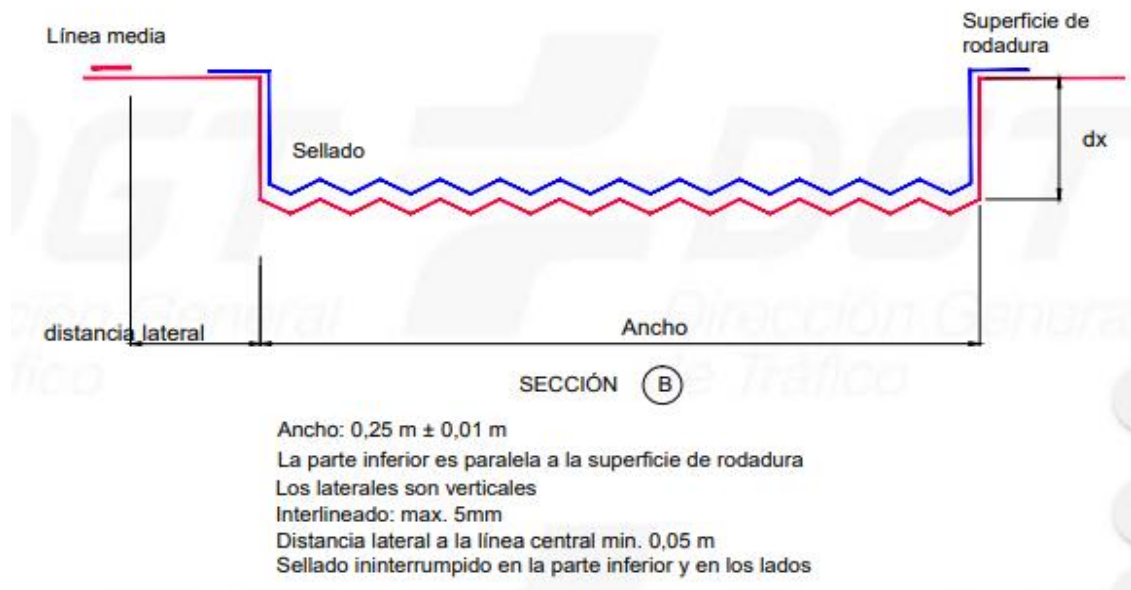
DGT (2018). Sección transversal de guía sonora longitudinal sinusoidal
